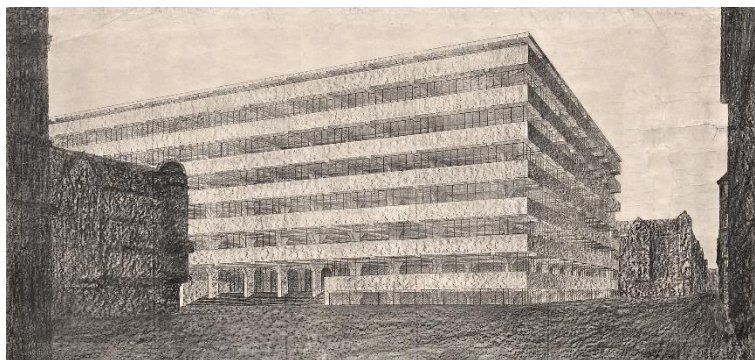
Perspectiva para o projeto Concrete Office Building (1923), Berlim.
